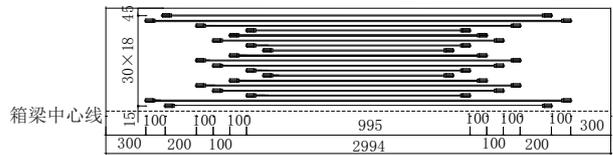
中跨箱梁 1/2 平面加固布置图(单位:cm)
